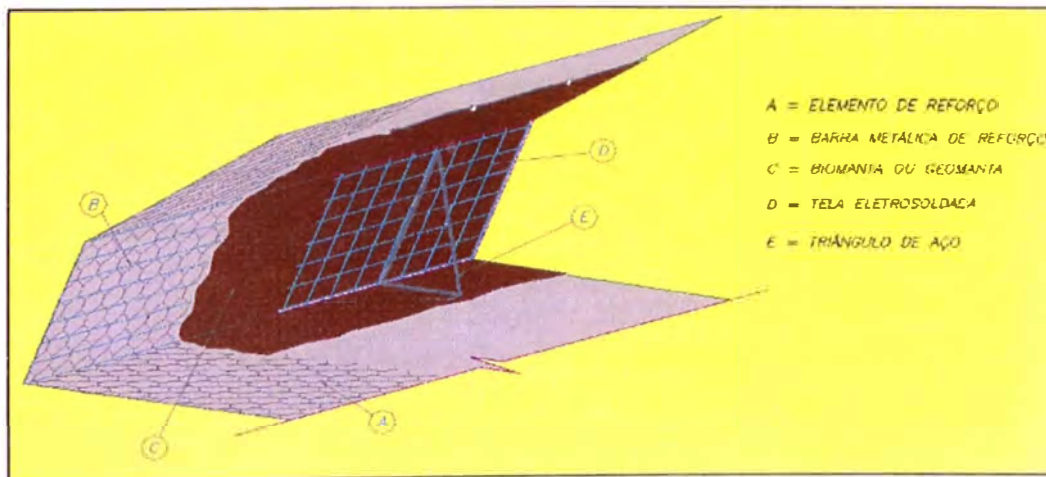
Fachada del suelo reforzado, detalles, Terramesh Verde.
